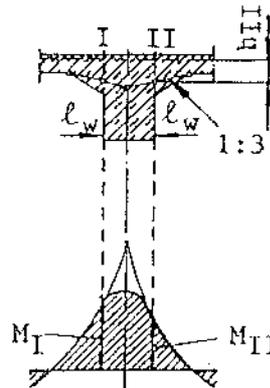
Reducción del diagrama de momentos flexores sobre un apoyo en el cual la pieza está rígidamente conectada, y momentos de dimensionamiento correspondientes.
